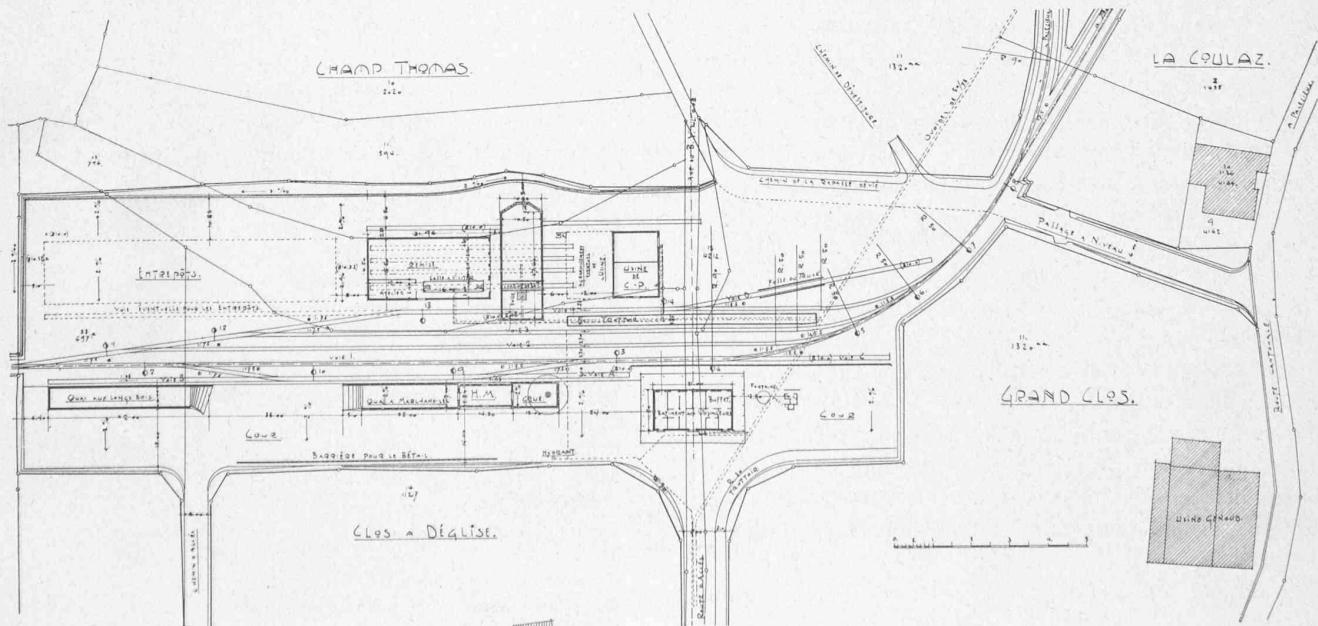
Plan de la gare de Châtel-St-Denis.
